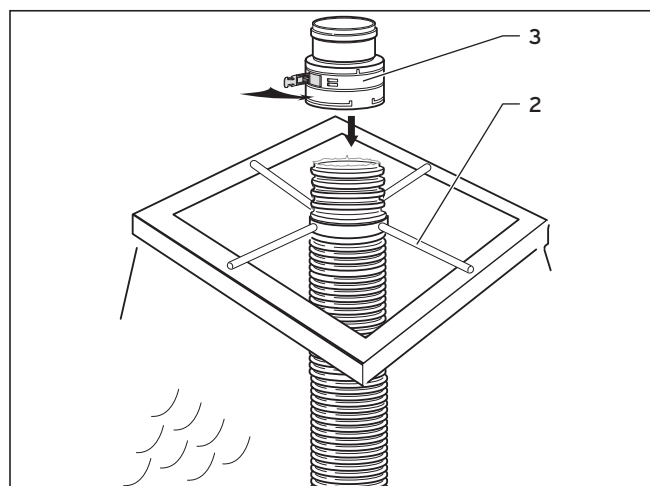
Élément de raccordement avec conduit des fumées flexible
